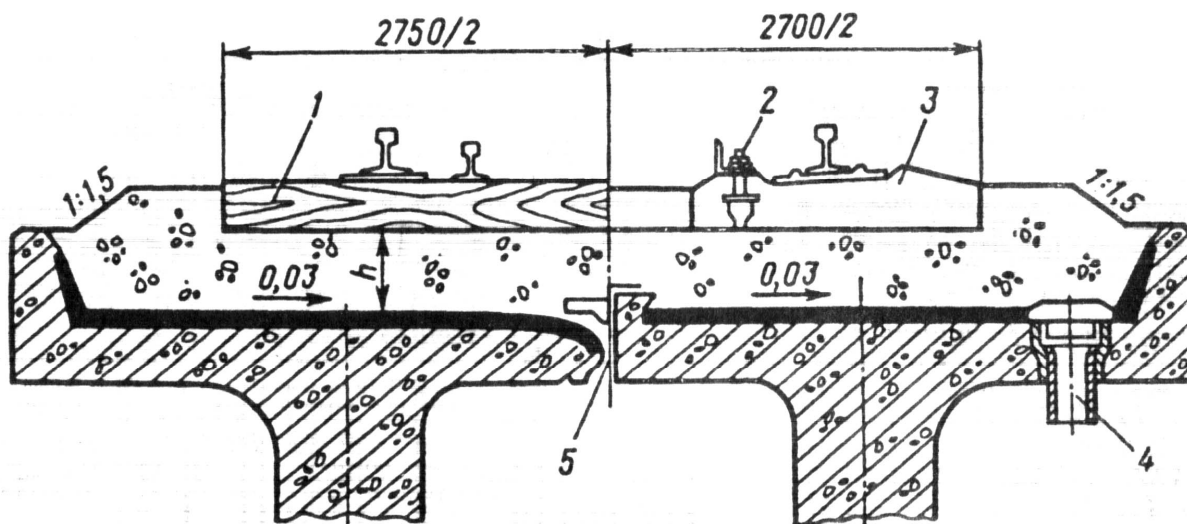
Мостове полотно з їздою на щебеновому баласті на дерев'яних (ліворуч) і залізобетонних (праворуч) шпалах: 1 – дерев'яні шпали; 2 – закладний болт кріплення контруктників; 3 – залізобетонна шпала марки Ш-1М з контруктниками; 4 – дренавальна трубка; 5 – дренавальна щілина.
